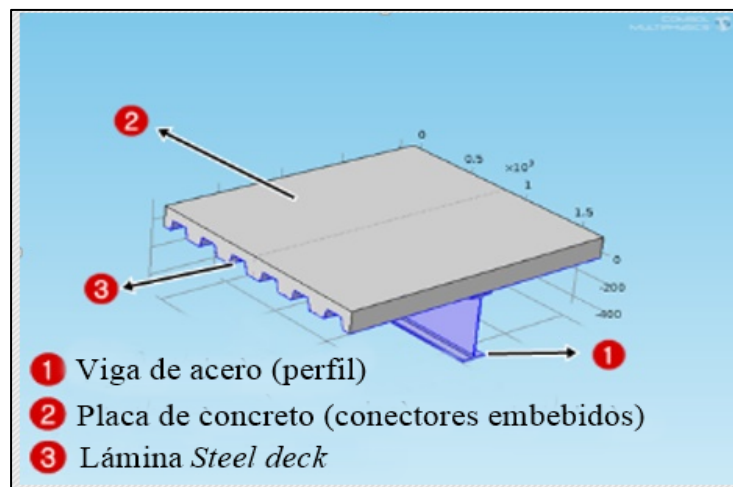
Sistema de losa en sección compuesta con nervios de la lámina perpendiculares al eje de la viga (después de fundir el concreto). Fuente: Autor
